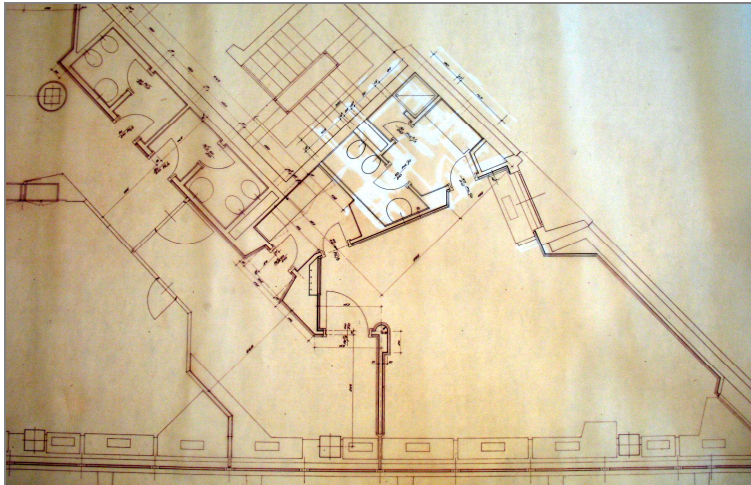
presidenza saipem proposta 1 (fonte CSAC – stralcio tav. 139, n. 384-3)
